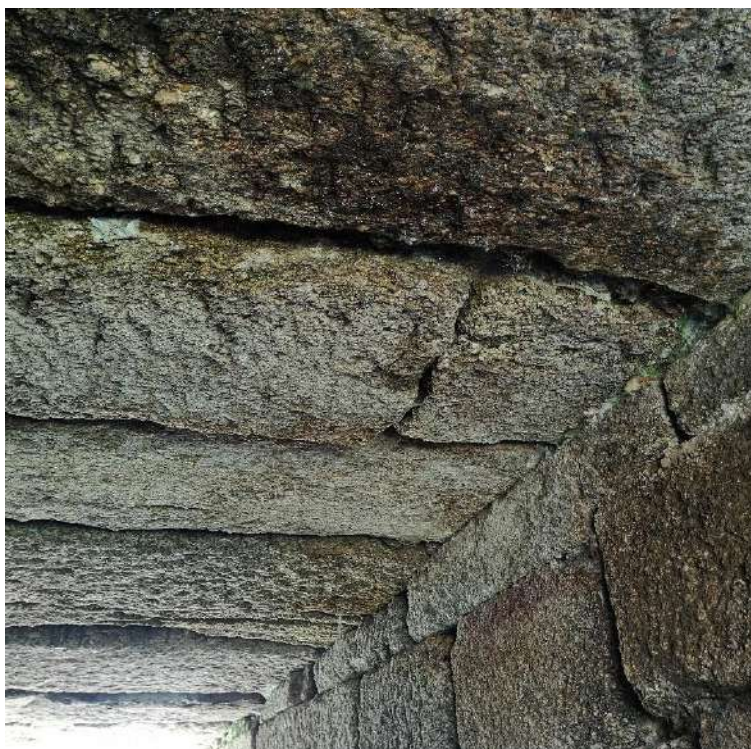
Lajeta fraturada na primeira secção de vazão, Alçado Norte, Encontro Oeste
